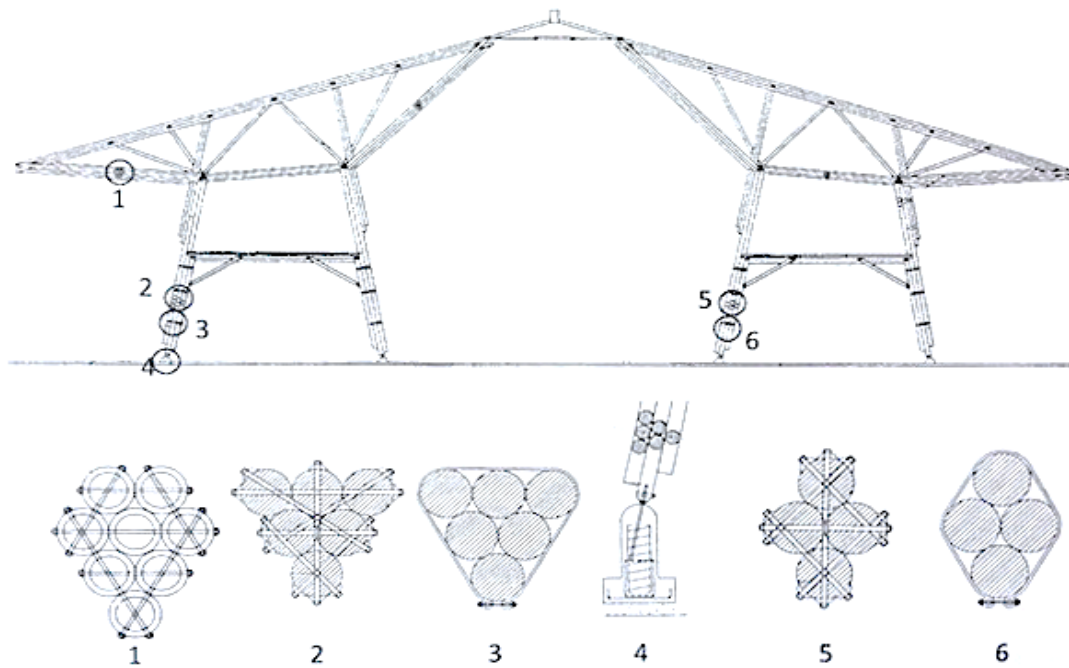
Pavilhão de Simón Veléz: alçado de sistema construtivo duo dimensional com cortes transversais representativos de colunas de sistema estrutural “pilar-viga”
